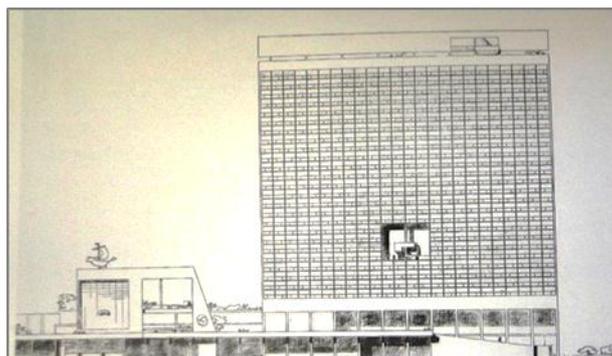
Estudo para a construção do novo hotel d'Orsay, fachada norte.
